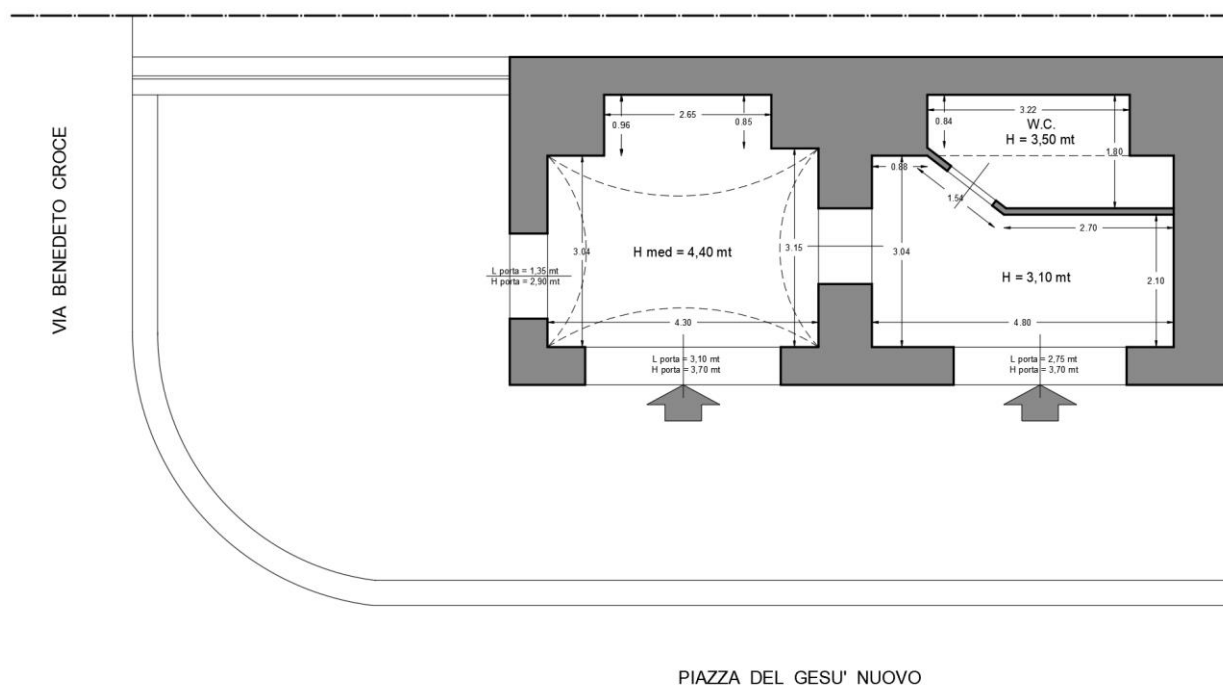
Schema planimetrico di individuazione delle funzioni di progetto
